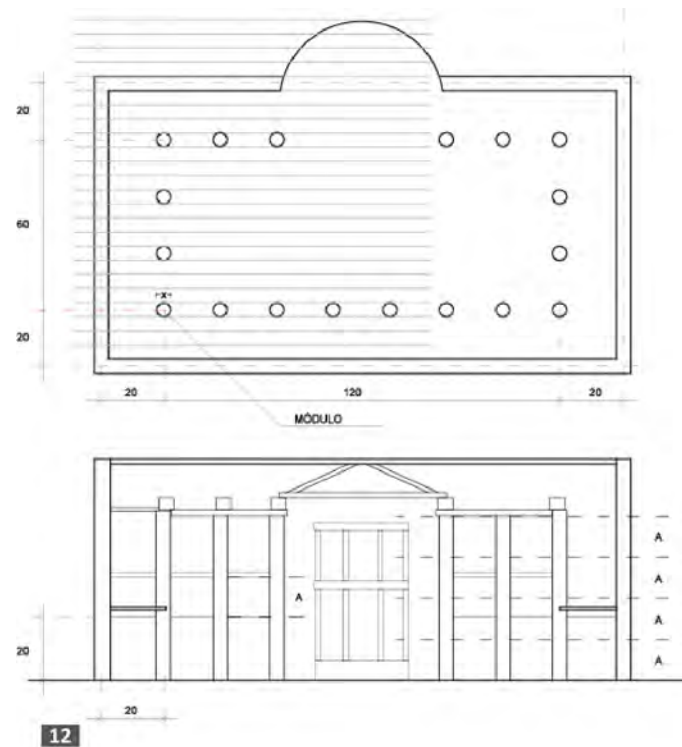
redesenho da basílica de Fano, planta e corte. Na planta observa-se a grelha oriunda do módulo.
